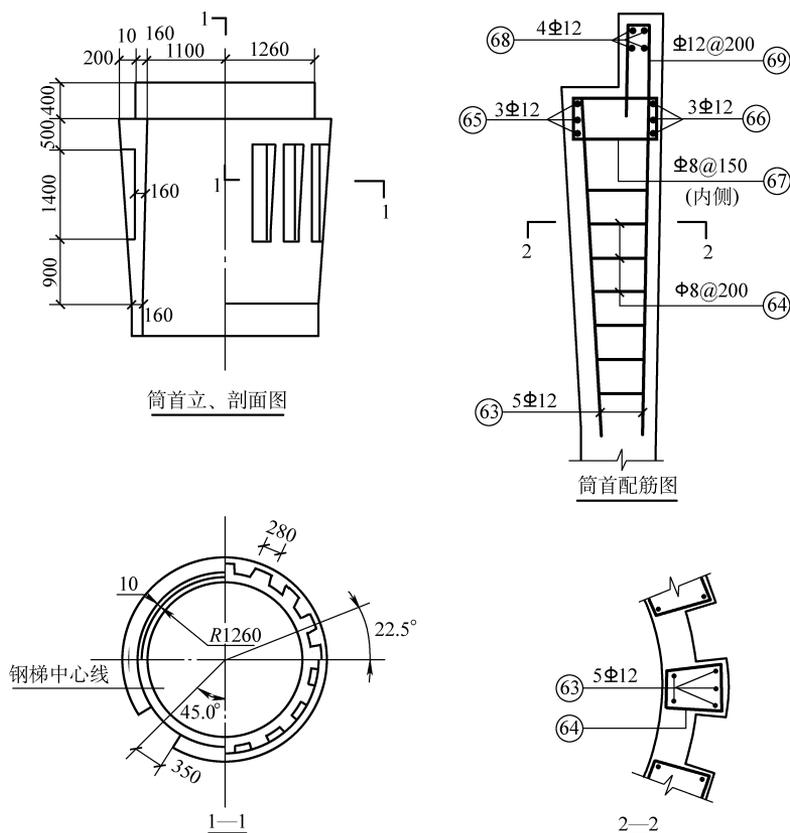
80m 高钢筋混凝土烟囱筒首配筋图
